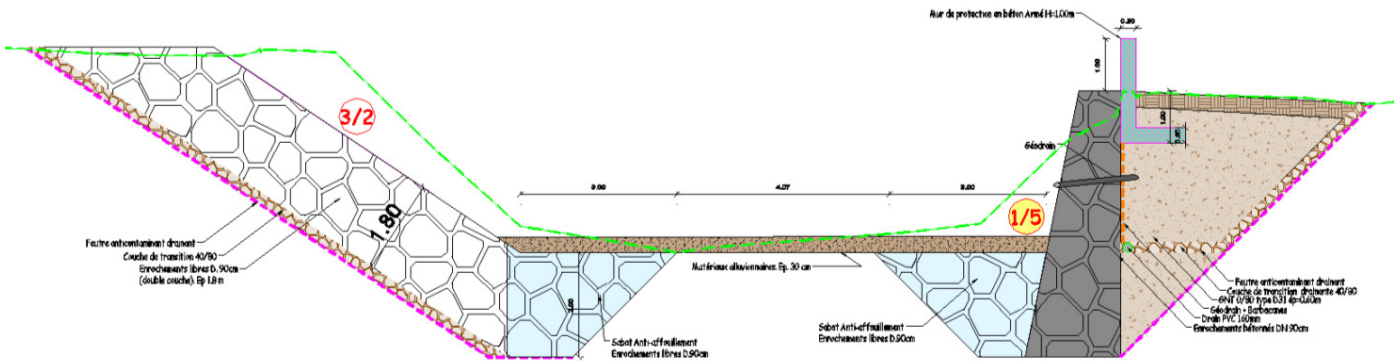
Coupe type - reprise des berges et rehausse du mur
